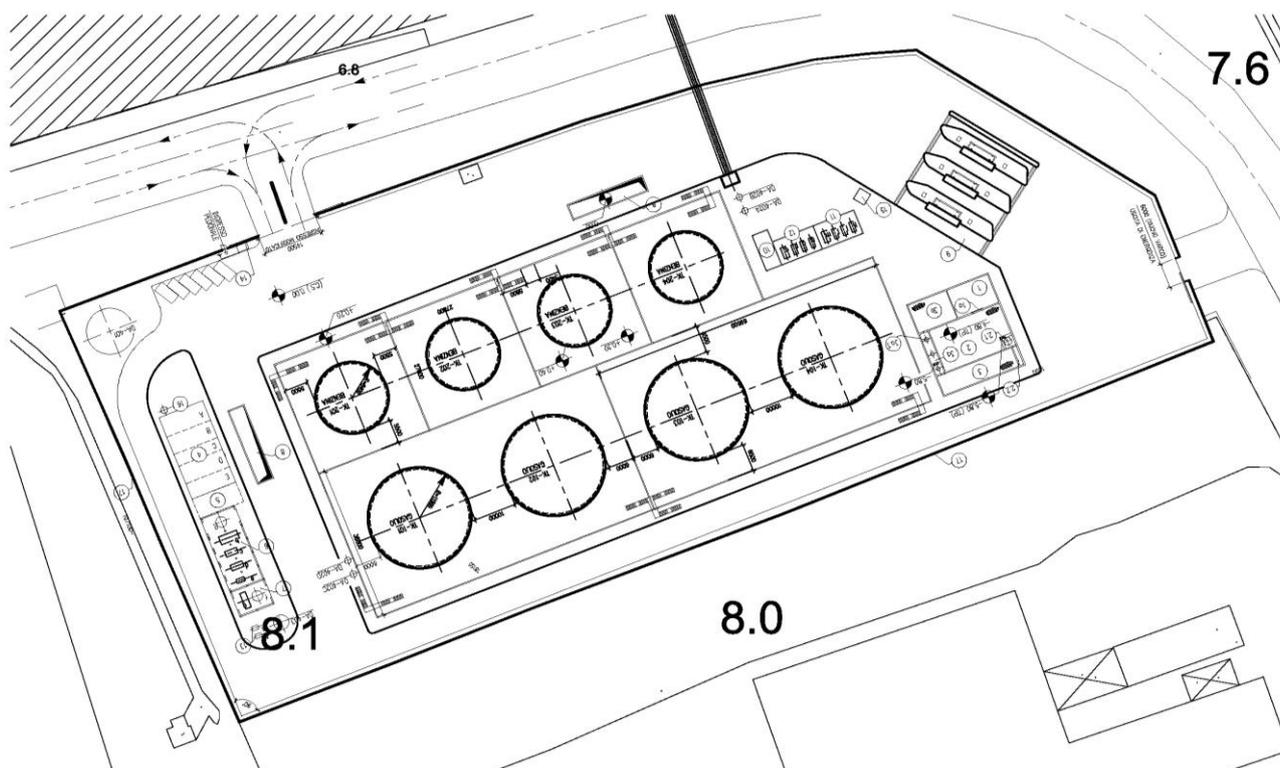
LAYOUT DI PROGETTO DEL DEPOSITO COSTIERO
